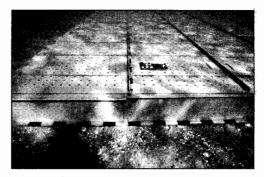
La Caja Fuerte cerrada vista desde el fondo del mar.
